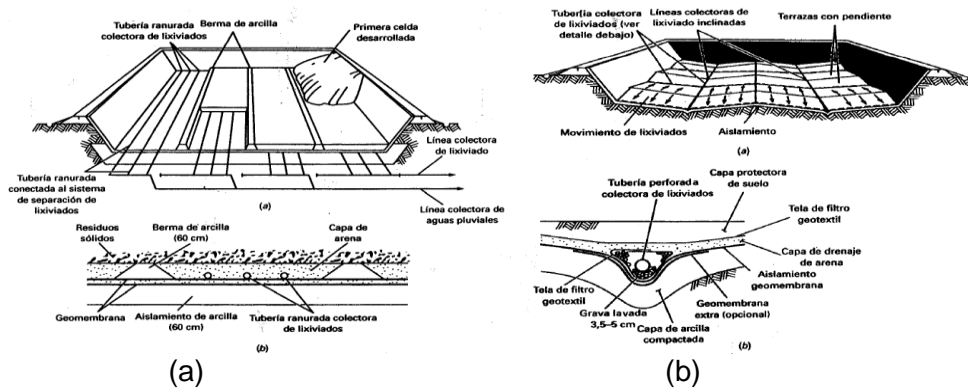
(a) Fondo con tuberías en el vaso del vertedero y tuberías longitudinales. (b) Terrazas inclinadas en el fondo del vertedero y sección transversal de un canal de recogida con tubería perforada.
